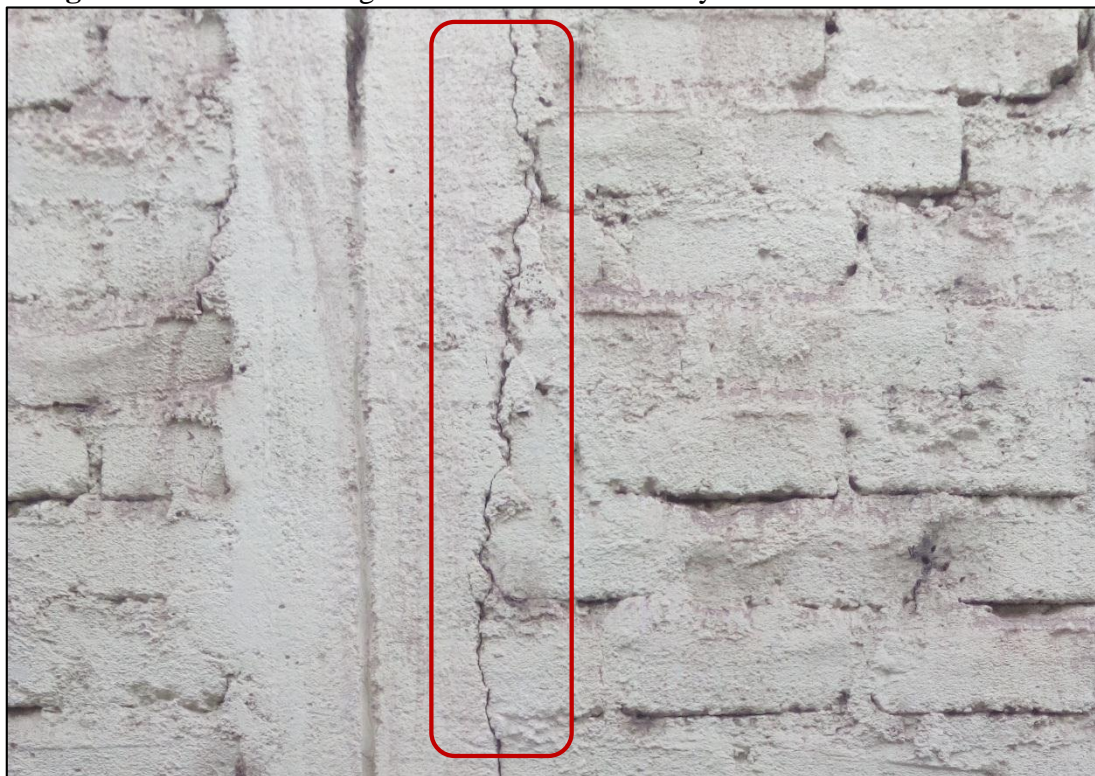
Presencia de fisuras en el pórtico de concreto armado en la UM-4.
